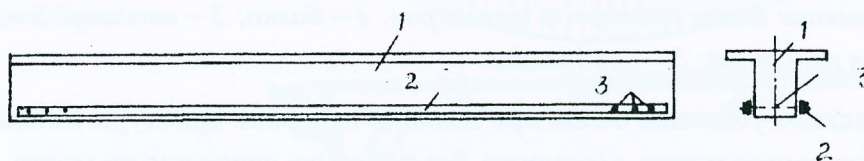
Усиление балки способом приклеивания полосовой арматуры: 1 – балка; 2 – боковая полосовая арматура; 3 – шпильки.
